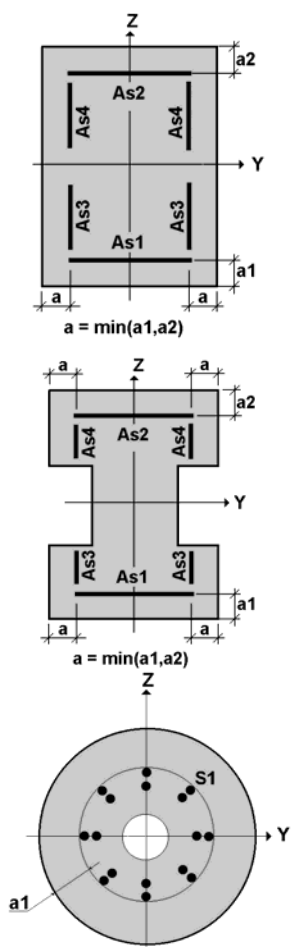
Размещение «площадей» продольной арматуры
